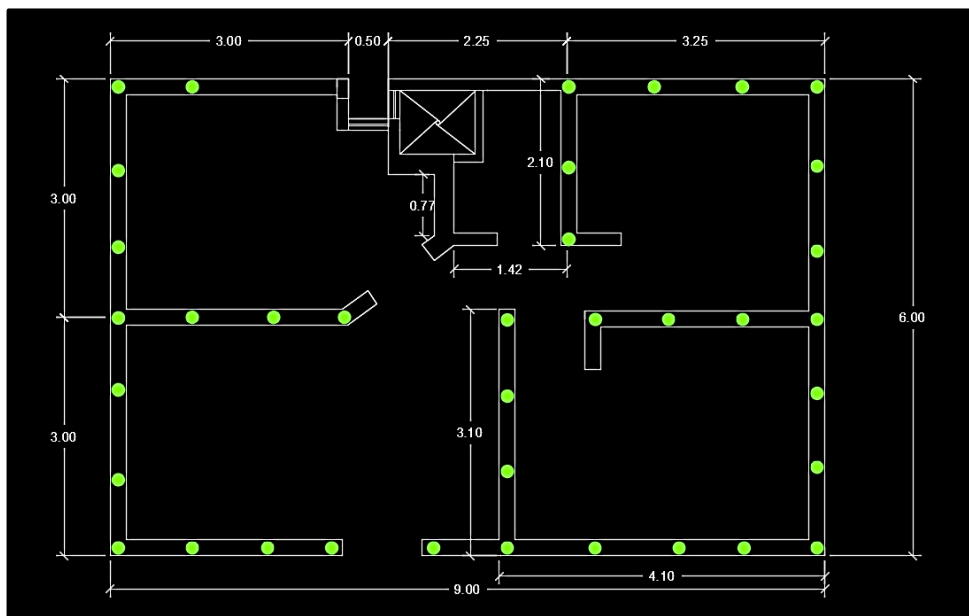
Plano de la vivienda B a nivel de mitad de muros. Los puntos verdes indican la ubicación de las columnas de pie.
